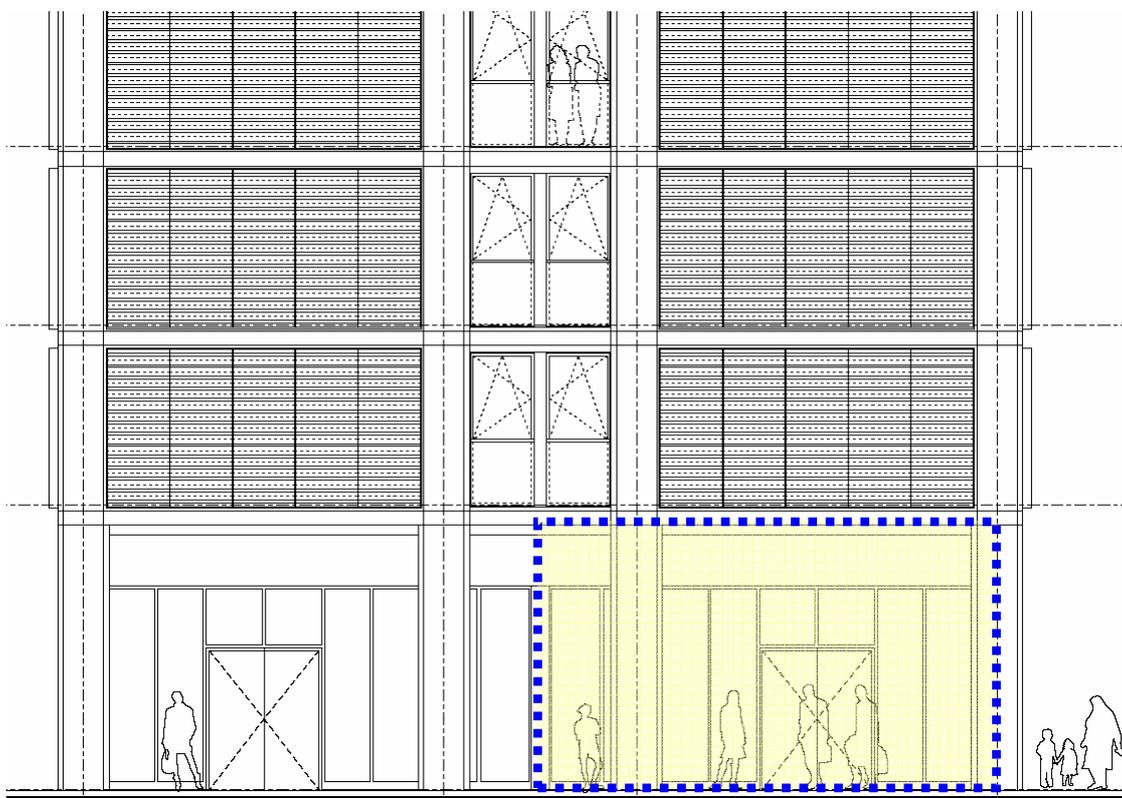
Indicazione in prospetto della facciata oggetto di valutazione
